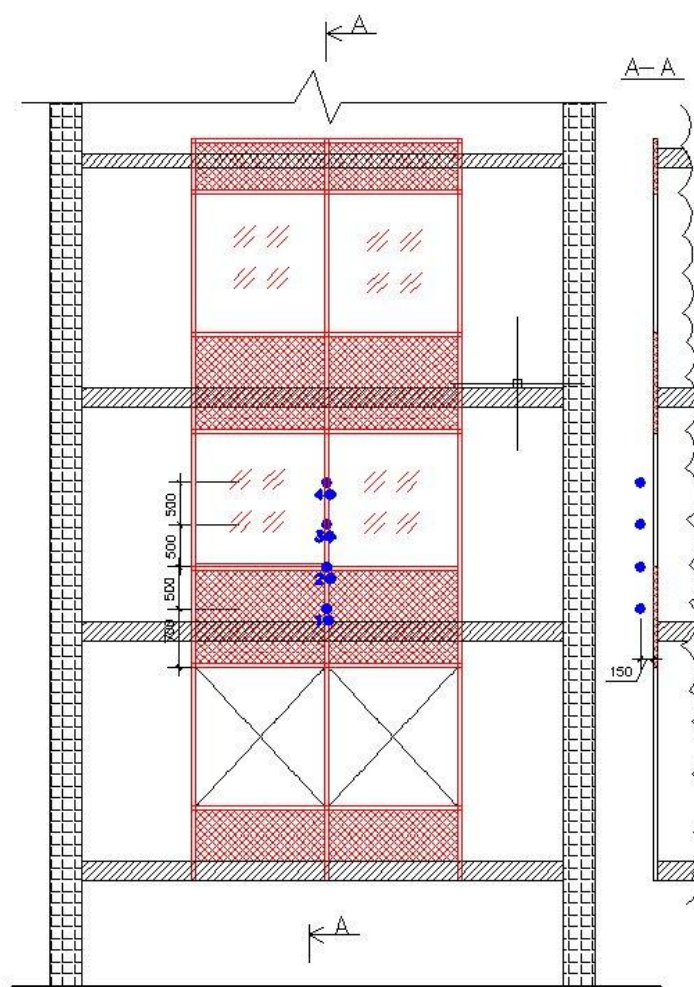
Схема расстановки термопар снаружи здания по вертикали фасада
